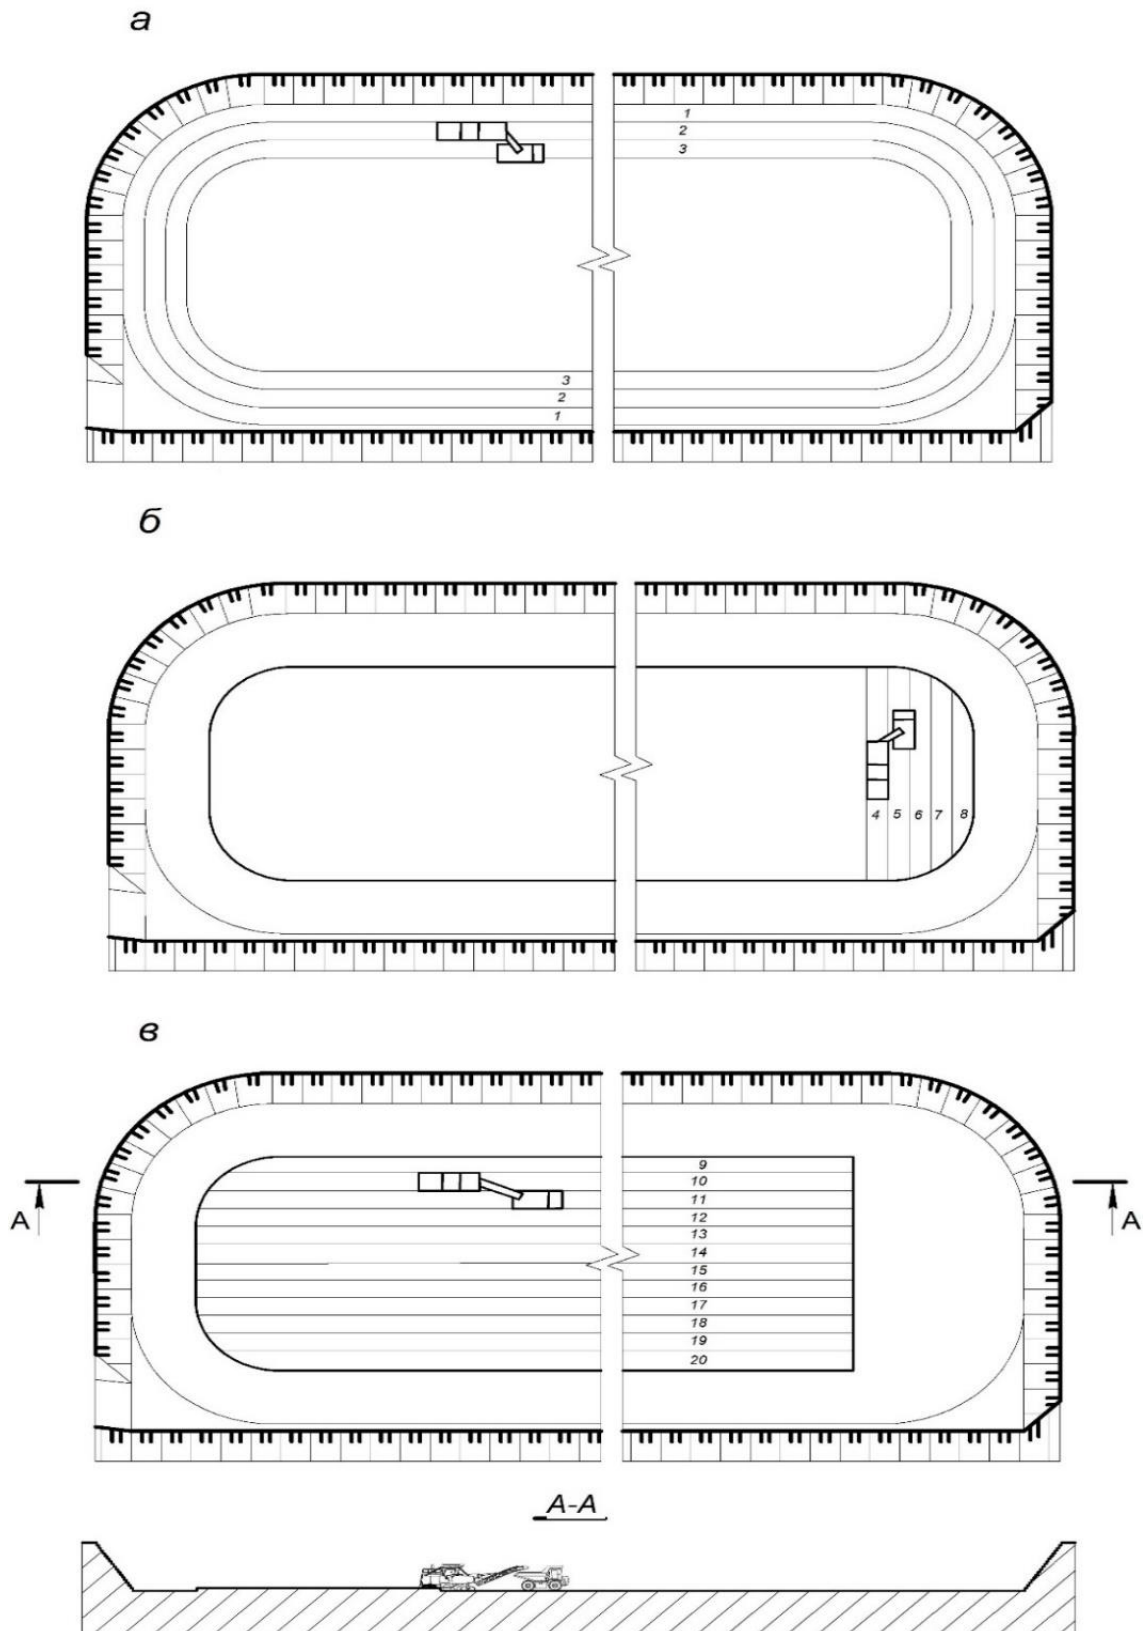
Човникова схема роботи фрезерного комбайну:
